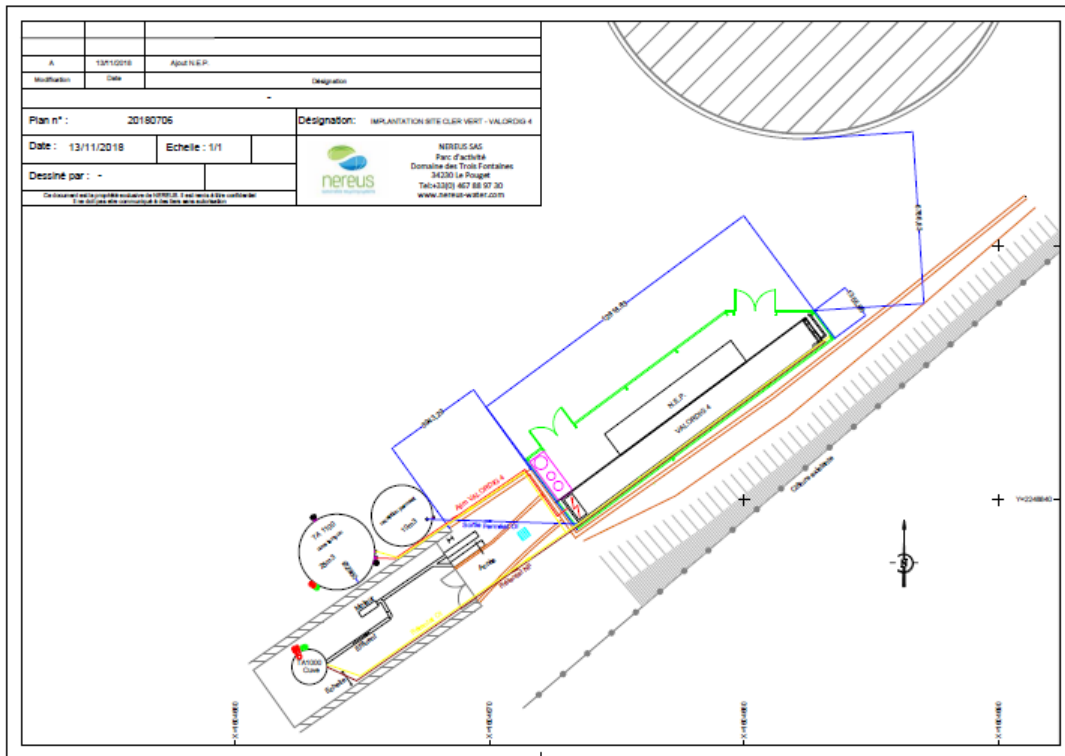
Schéma d'implantation sur site à Bélesta-en-Lauragais
